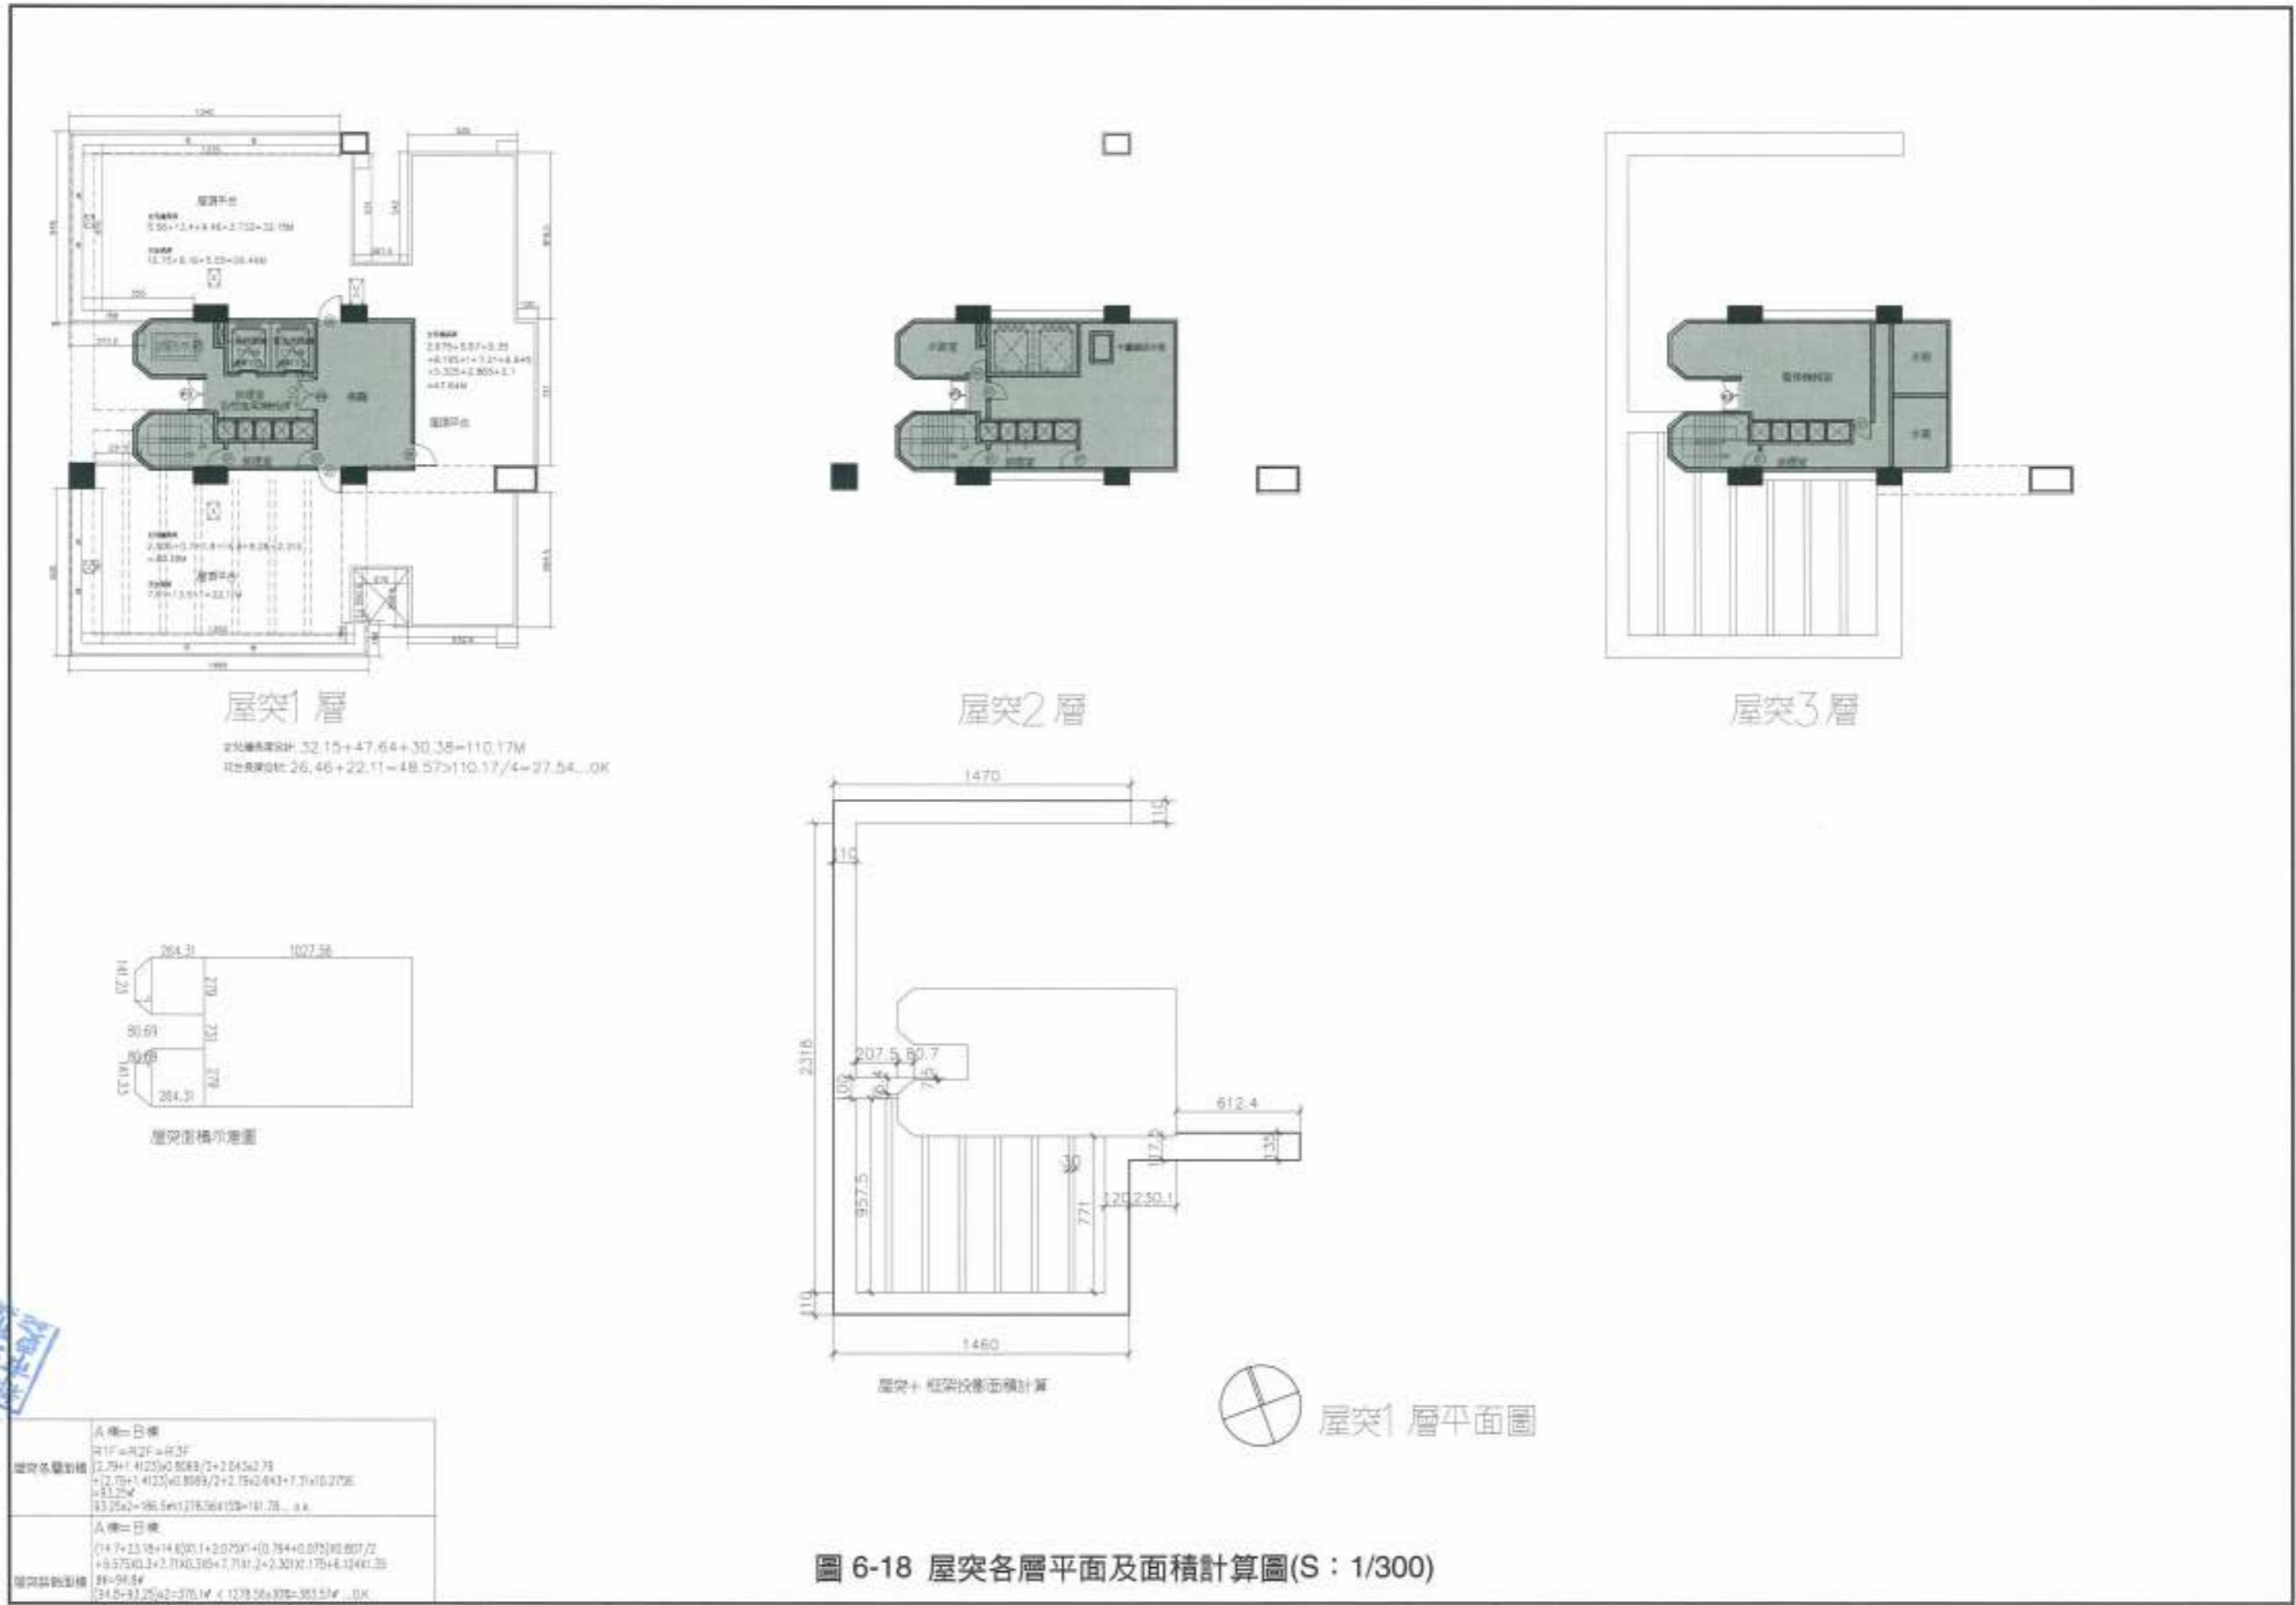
屋突各層平面及面積計算圖(S : 1/300)
